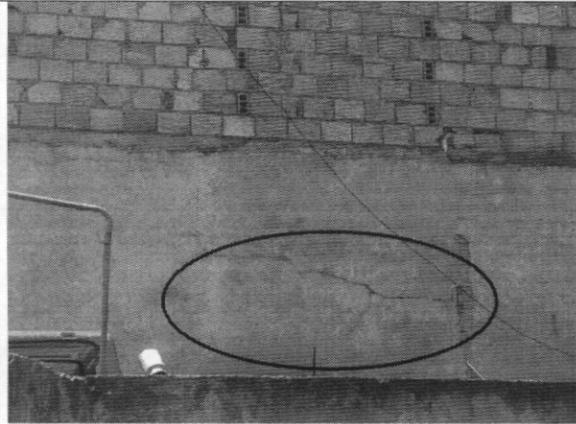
Fisura en acabado muro de culata costado sur
